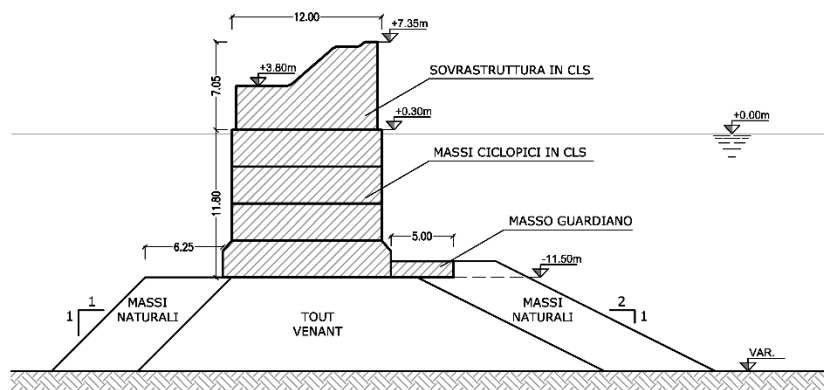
SEZIONE TIPO DEL TRATTO ALL'ESTREMITÀ DI PONENTE DELLA DIGA ESISTENTE – TRATTO C-C'
